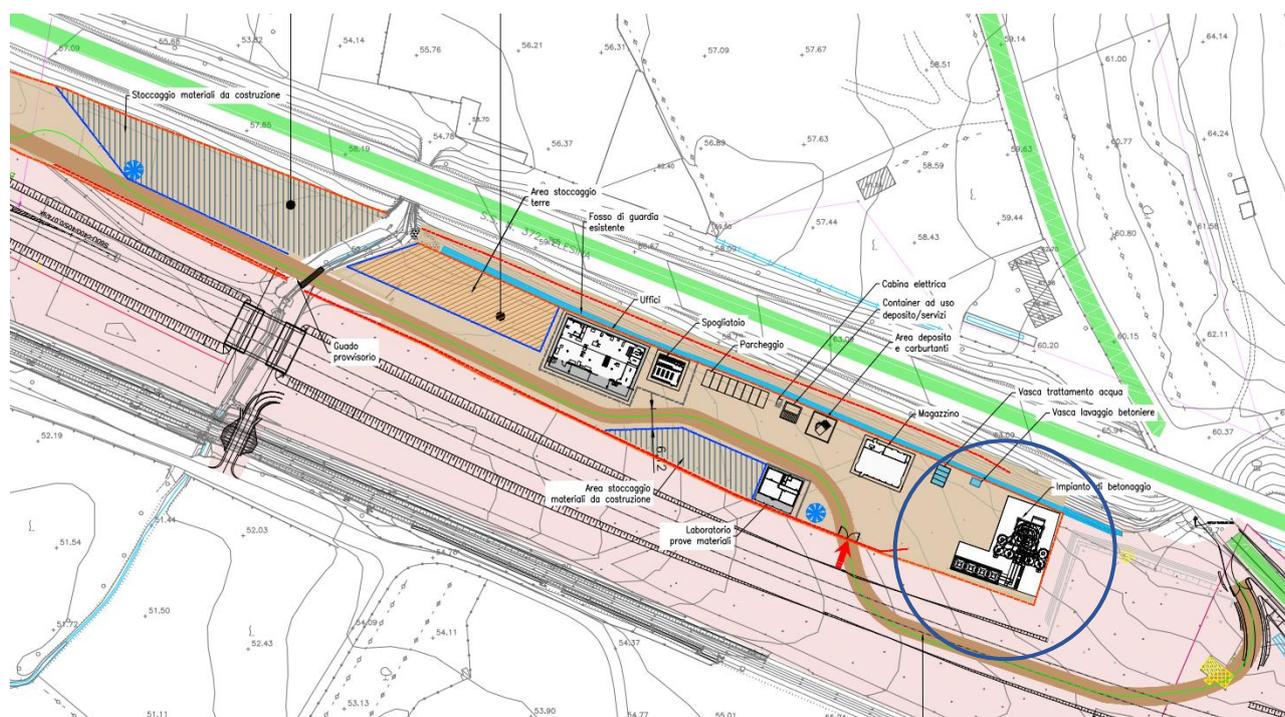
Planimetria CO1L2 con indicazione impianto di betonaggio
